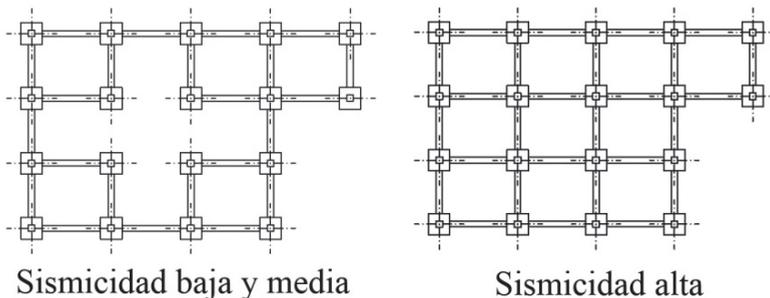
Disposición de vigas de atado entre zapatas según la sismicidad
